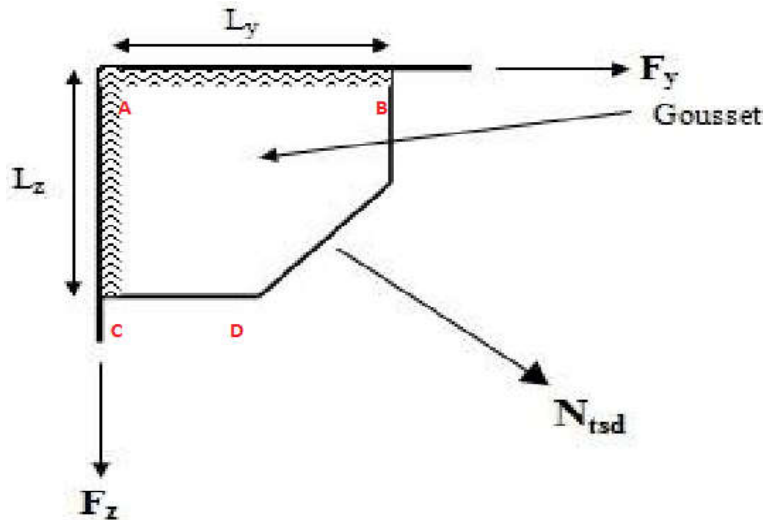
assemblage gousset nœud du portique par cordon de soudure.
